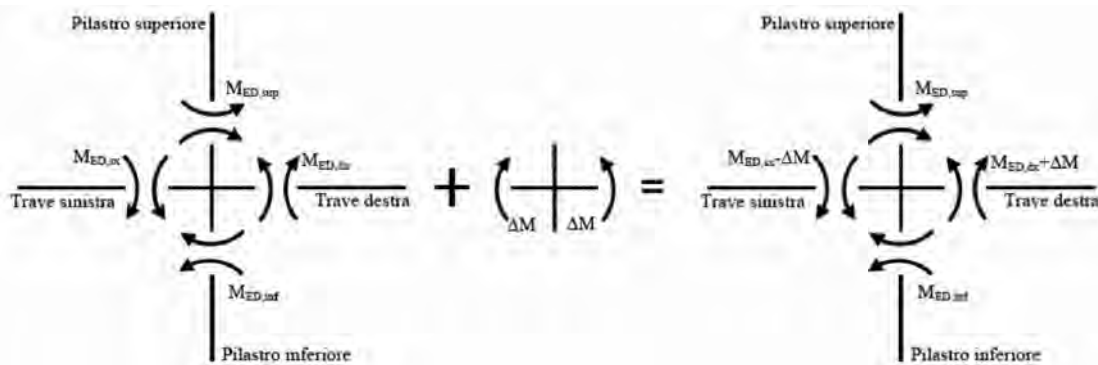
Momenti d'estremità di verso concorde: redistribuzione dei momenti nelle travi
